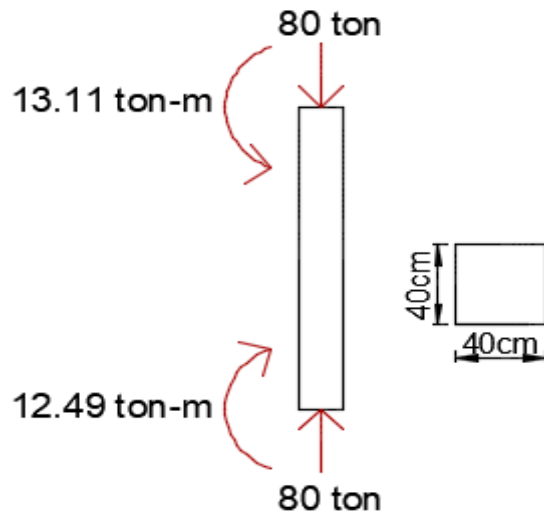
Sección de la columna rectangular del pórtico y las cargas actuantes
